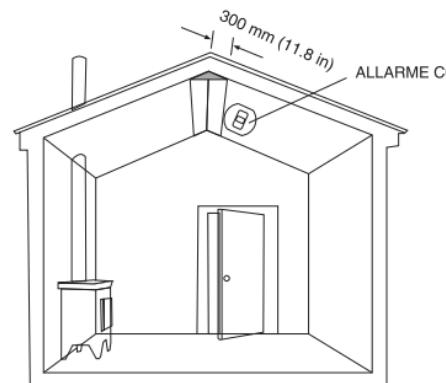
In stanze con soffitti inclinati, il rilevatore di CO dovrebbe essere posizionato sul lato alto della stanza
